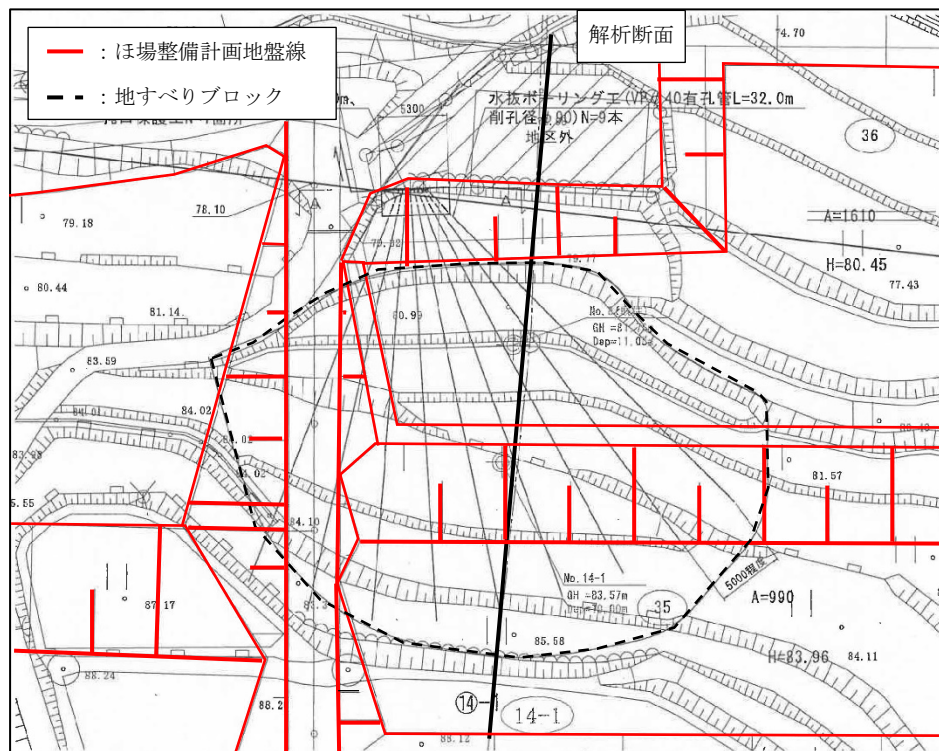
生田大坪地区14-1ブロック 対策工計画平面図
